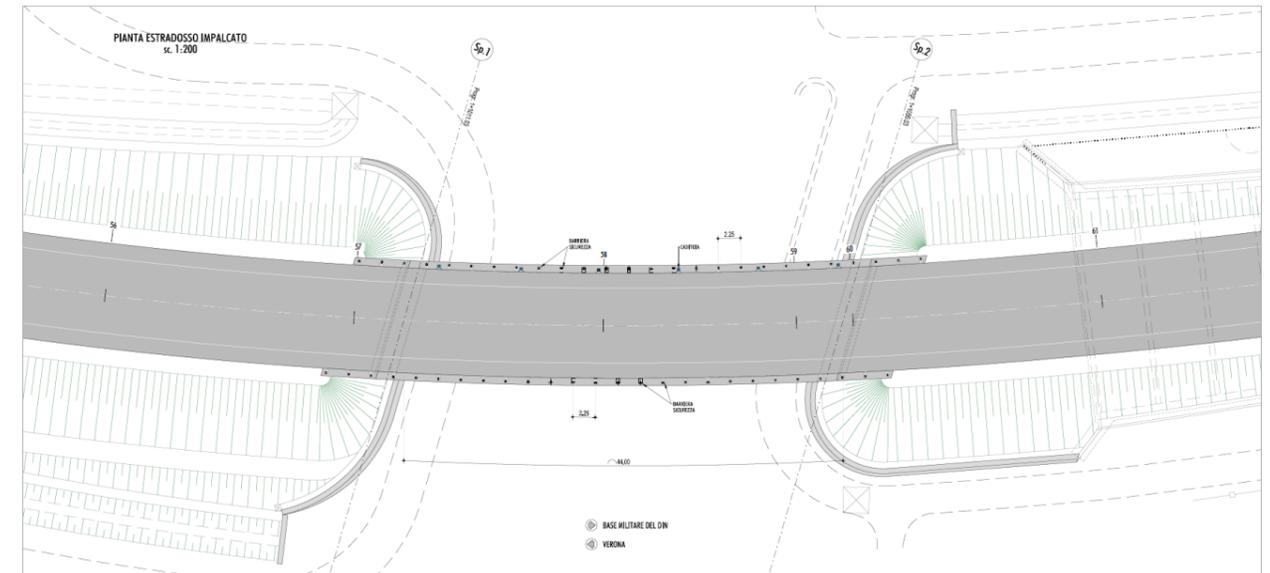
VISTA IN PIANTA DEL PONTE – LIVELLO IMPALCATO
